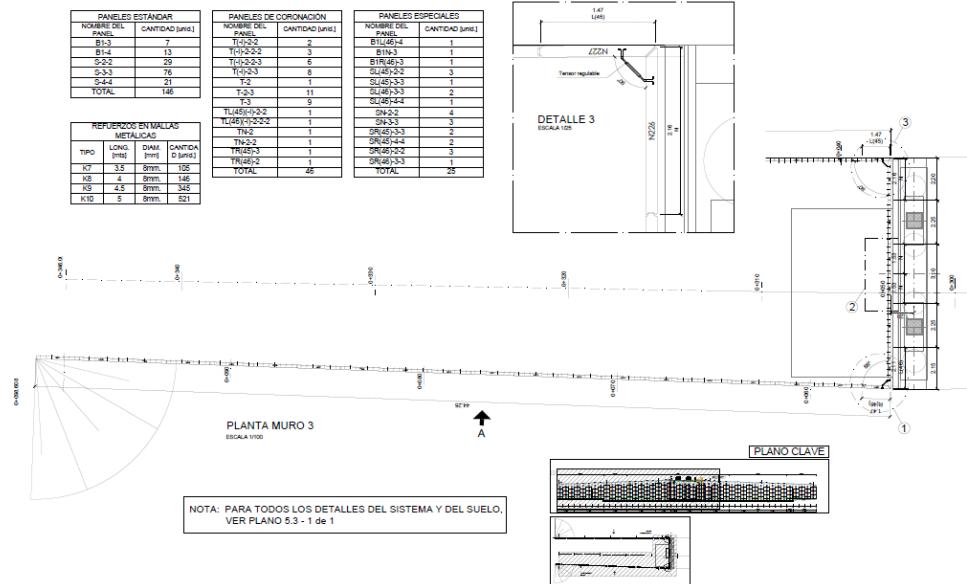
Geometría de los Muros de Contención 3, y Falso Estribo 2.
